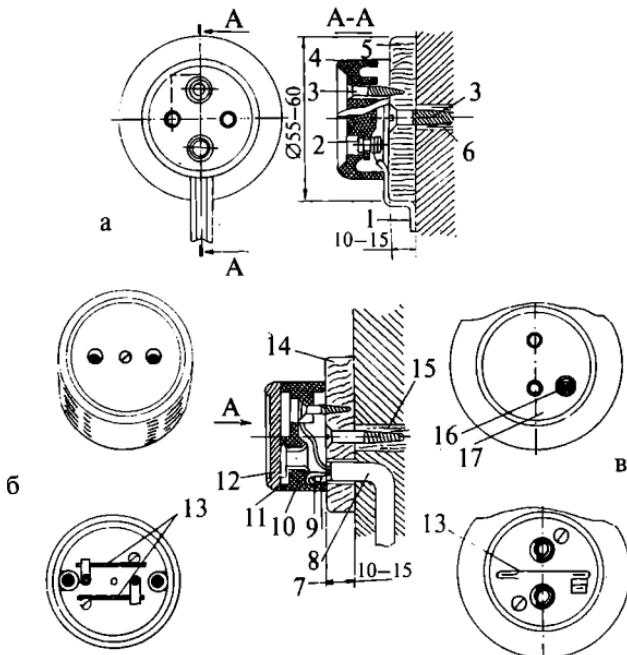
Розетки с цилиндрическими гнездами: а — резьбовое крепление гнезд; б — крепление гнезд завальцовкой и наличие двух предохранителей; в — крепление гнезд завальцовкой и наличие одного предохранителя; 1 — проводник; 2 — гнездо с резьбовым креплением; 3 — шуруп; 4 — корпус; 5 — подрозетник; 6 — дюбель распорный; 7 — изолирующая трубка; 8 — основание; 9 — винт; 10 — шайба удлиненная; 11 — шайба круглая; 12 — гнездо с завальцовкой; 13 — предохранитель; 14 — подрозетник с отверстиями; 15 — пробка деревянная; 16 — гайка четырехугольная; 17 — крышка
